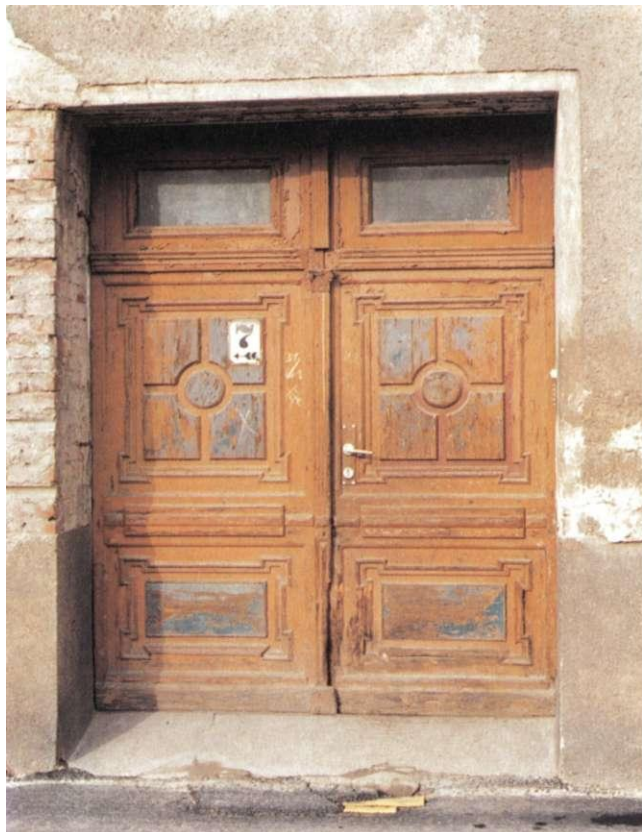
Wiederhergestellte alte Hauseingangstür in der Klosterbergstraße 25 ▼
